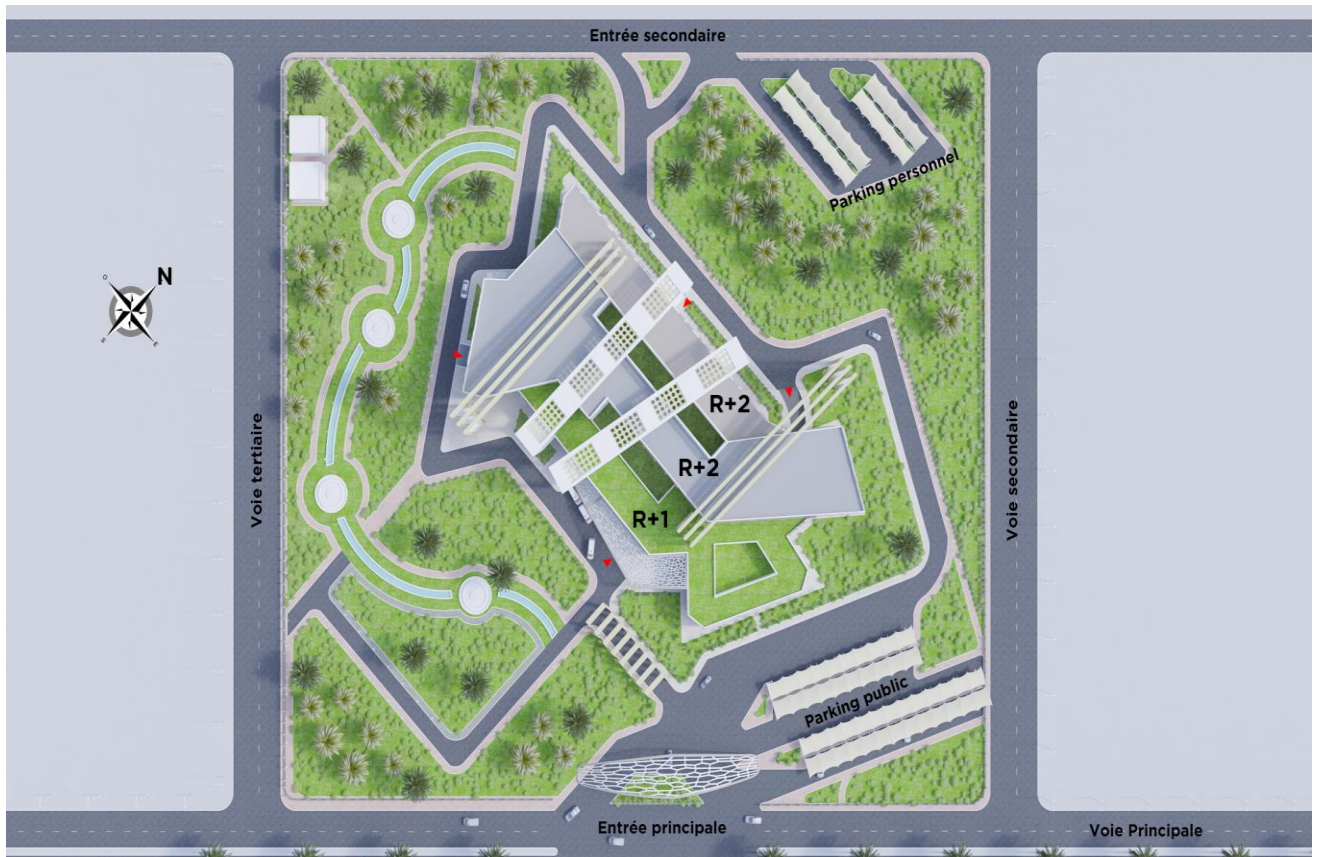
vue générale sur plan de masse du projet Source : auteur
